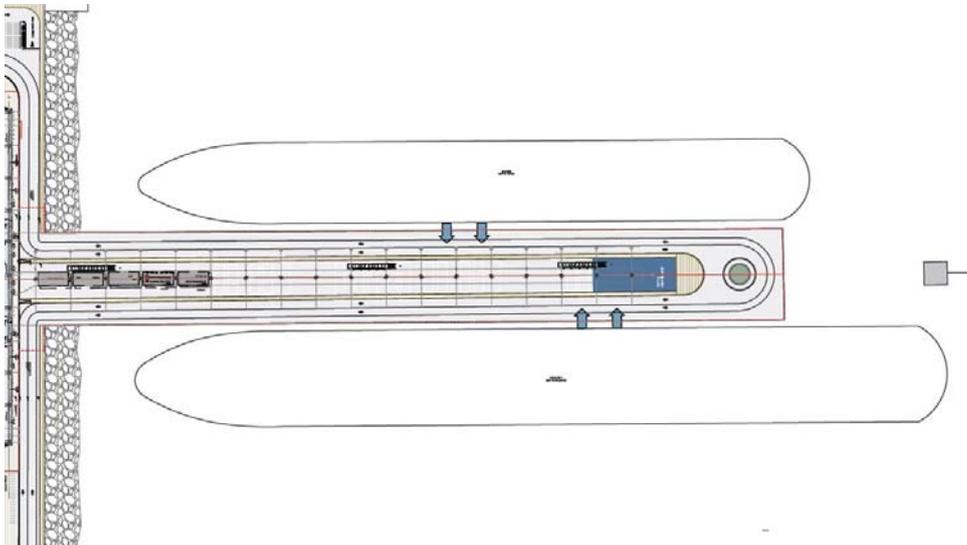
planimetria generale, Banchina crociere ed impronta delle navi (lato Est)
